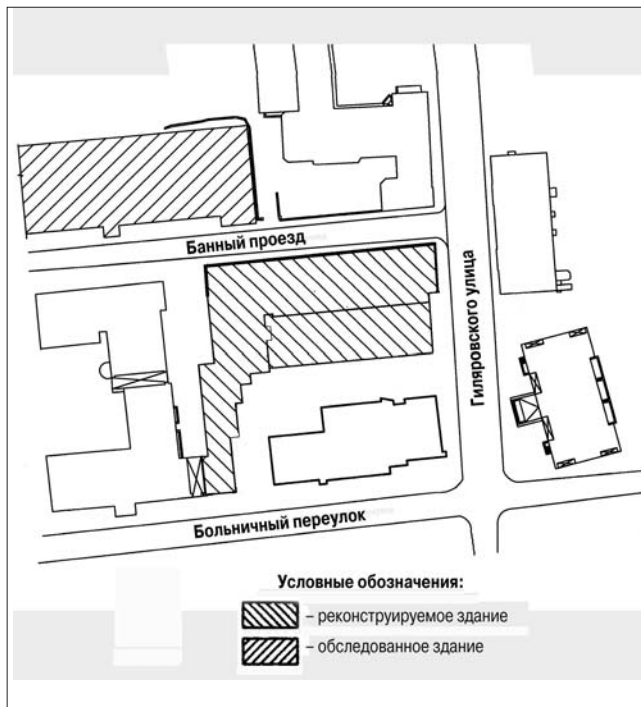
Схематический план здания, попадающего в зону реконструкции здания по адресу: ул. Гиларовского, д. 55, корп. 1
